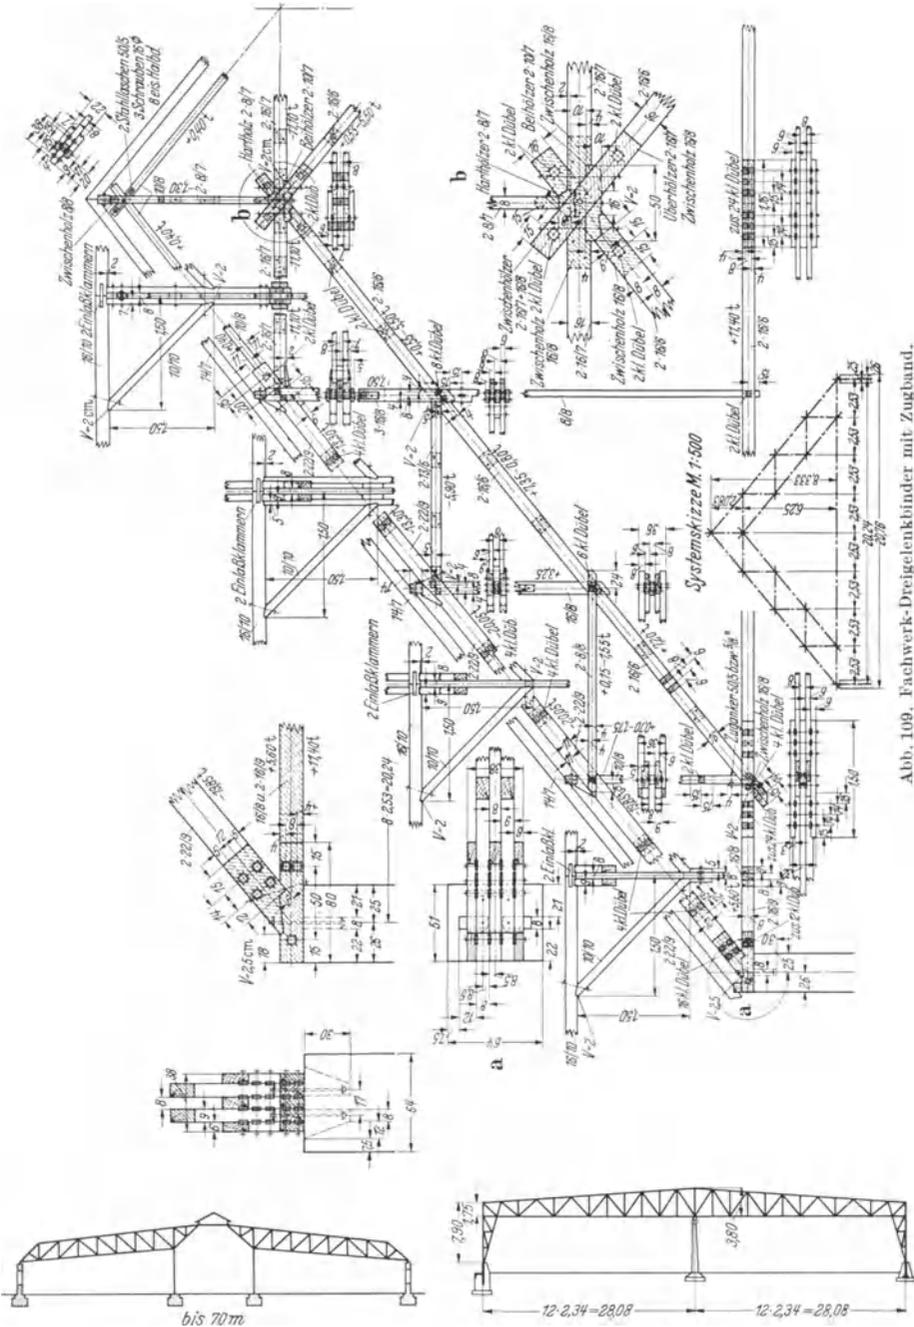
Fachwerk-Dreigelenkbinde mit Zugband.
